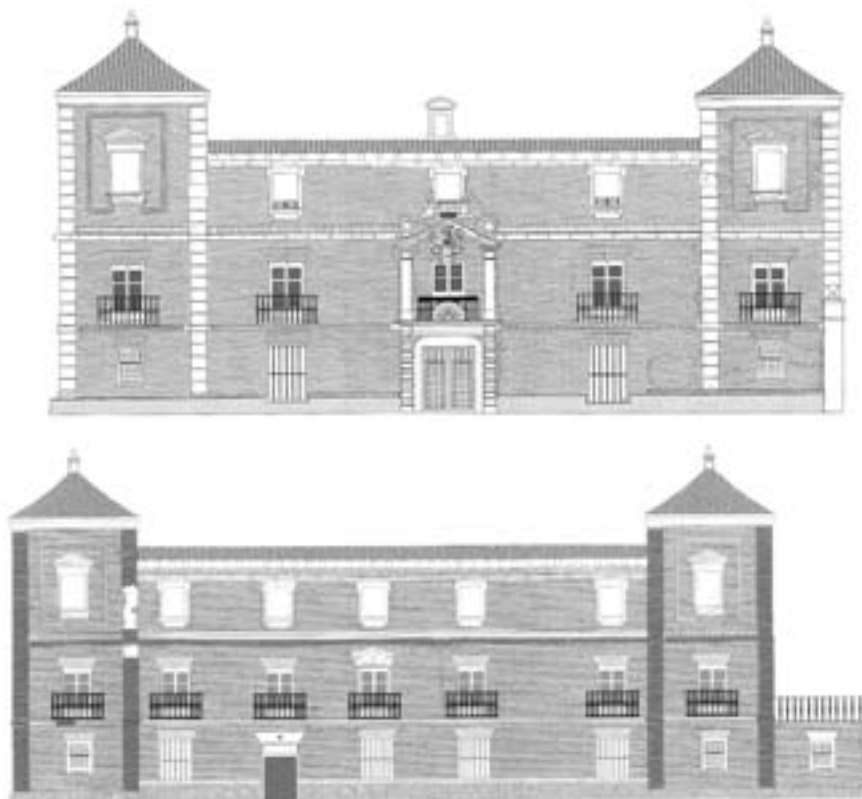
Vistas de las fachadas norte y oeste en la actualidad. Levantamiento fotogramétrico.
